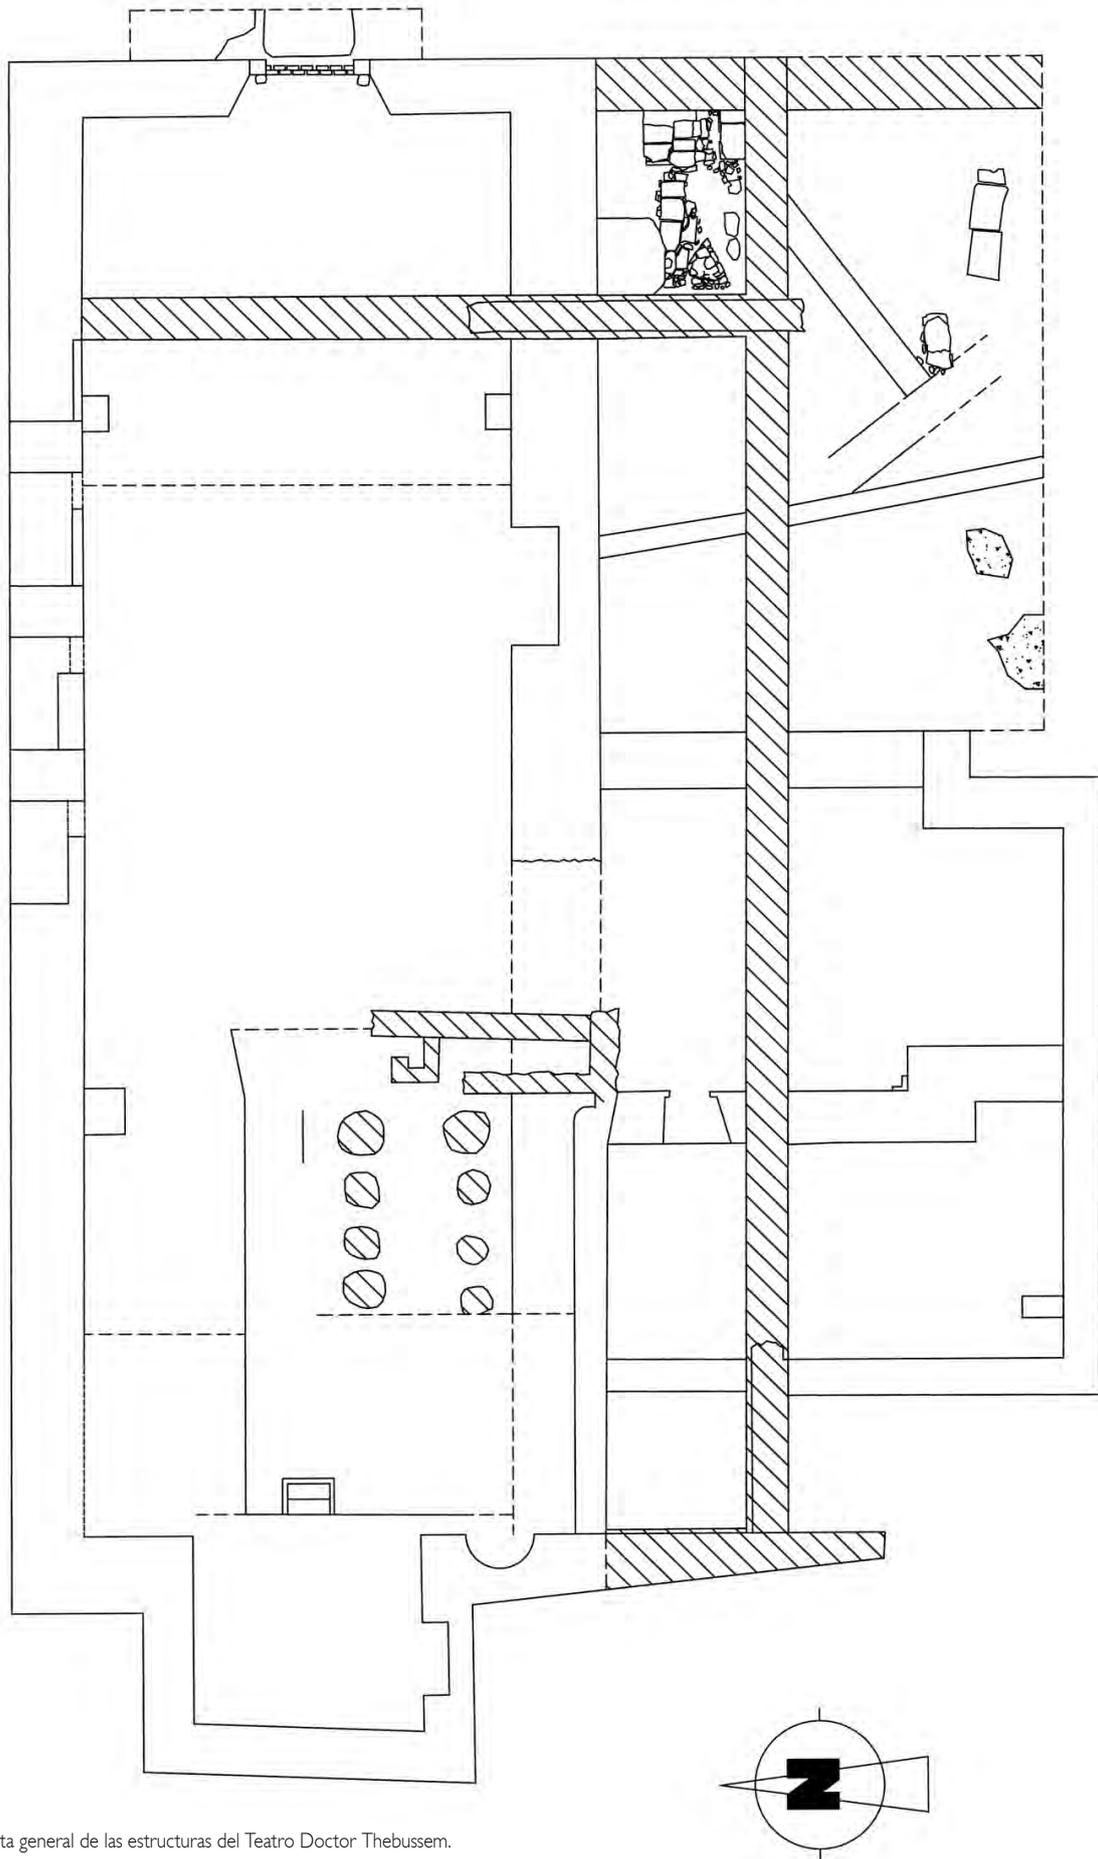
Planta general de las estructuras del Teatro Doctor Thebussem.
